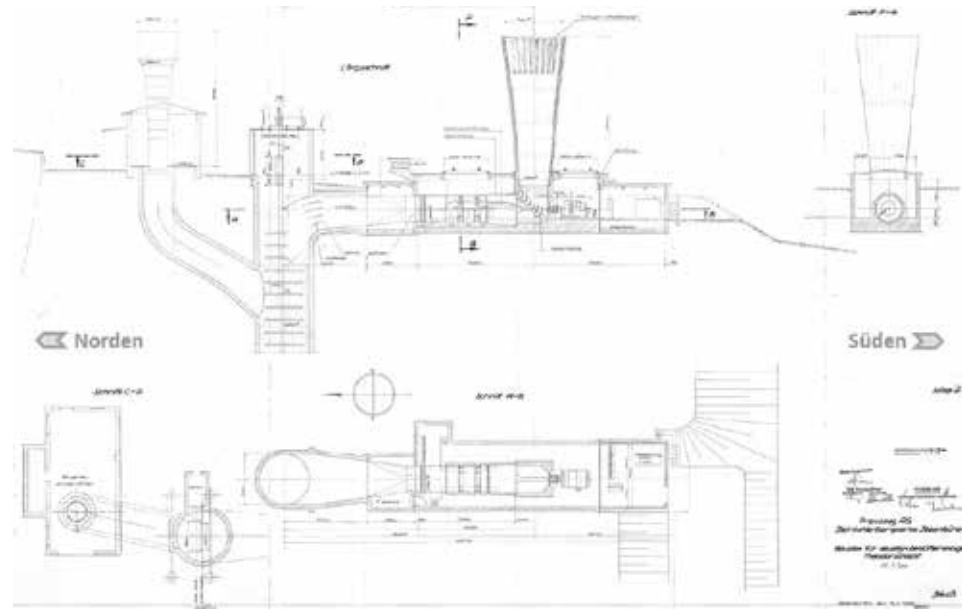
Bauplan für Hauptlüfteranlage, 1969
